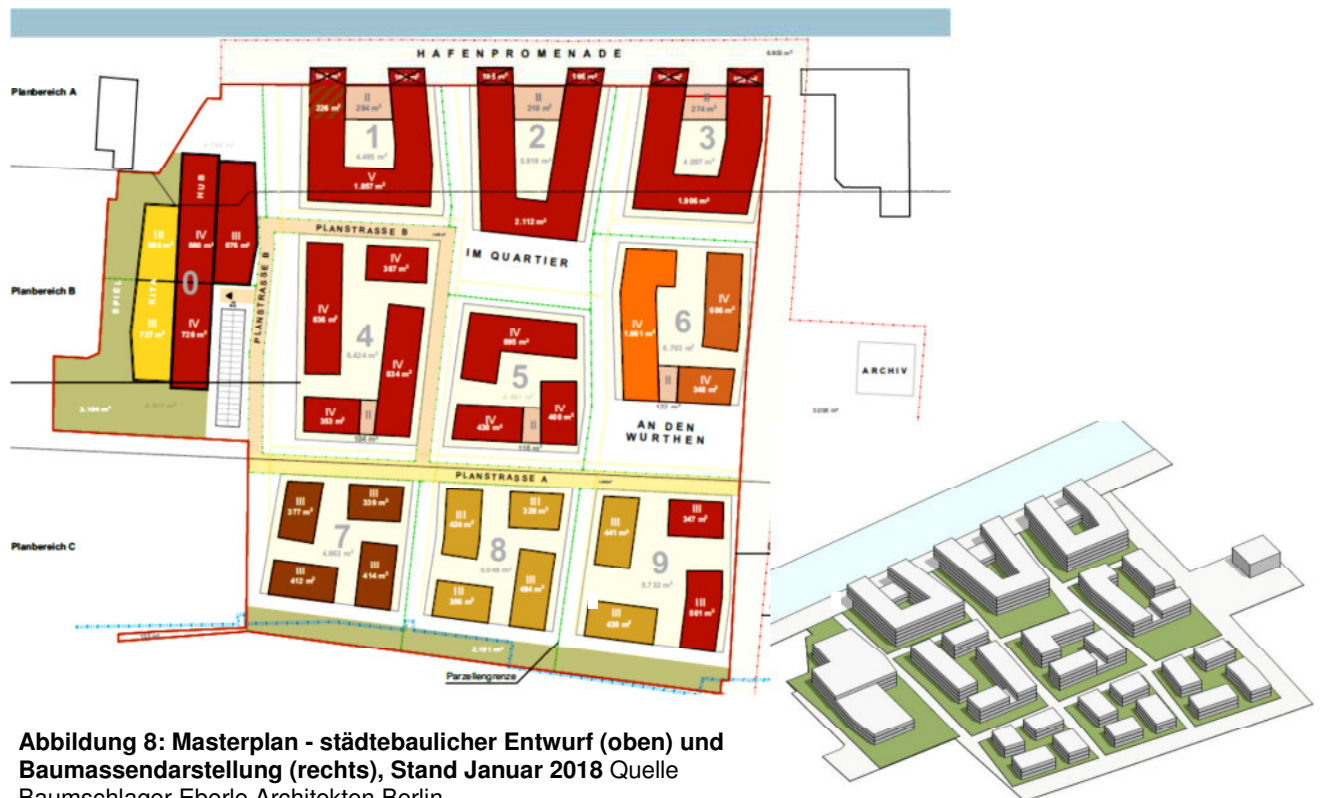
Masterplan - städtebaulicher Entwurf (oben) und Baumassendarstellung (rechts), Stand Januar 2018 Quelle Baumschlager Eberle Architekten Berlin,
